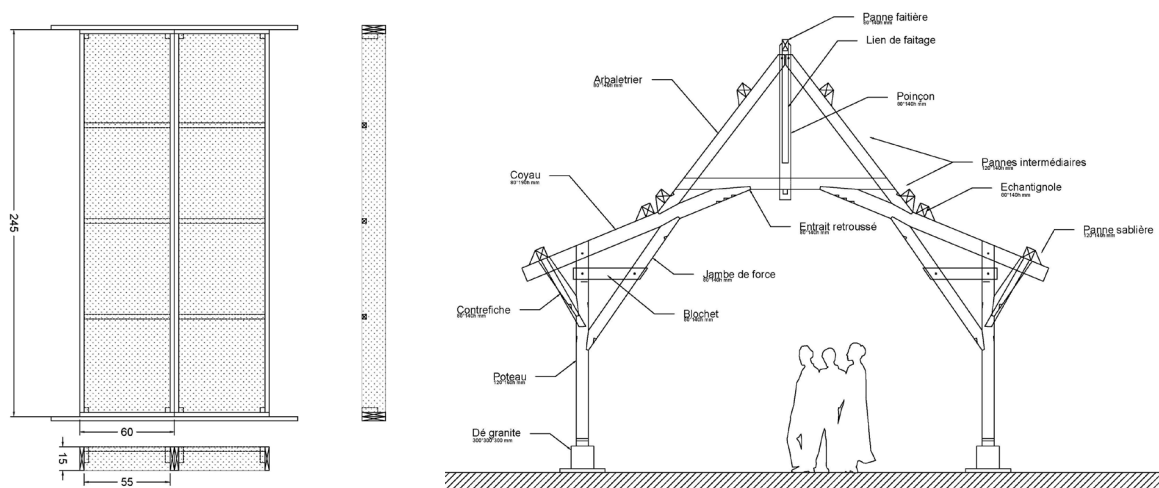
Dessin technique de panneau démontable d'isolation et de charpente
